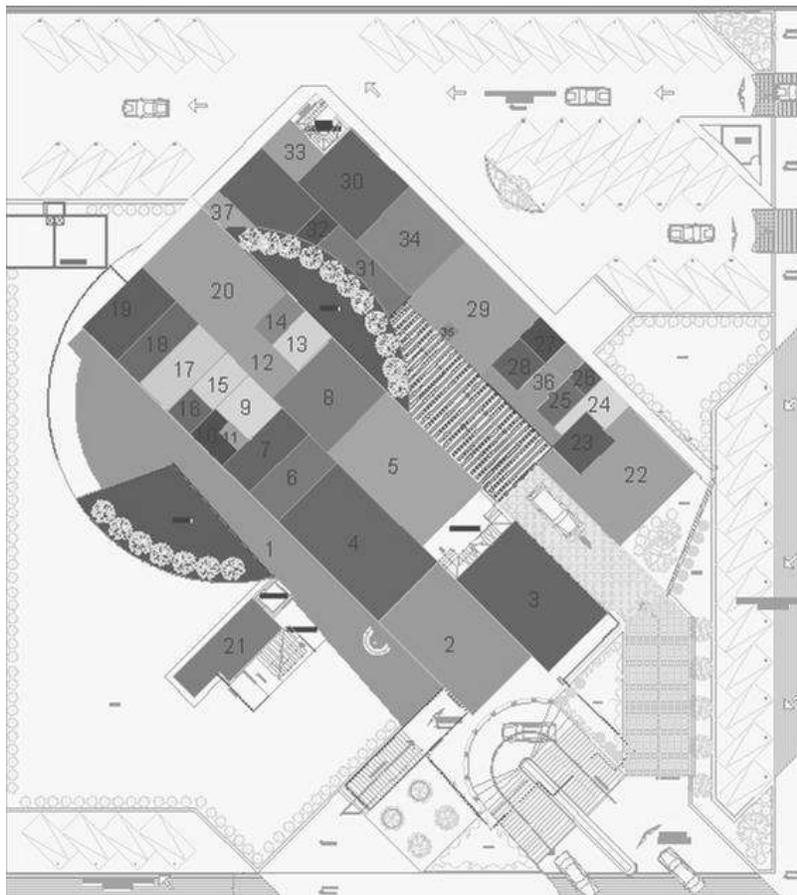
UMAA Zonificación Planta Baja. Elaborada por la autora. Mayo 2012
